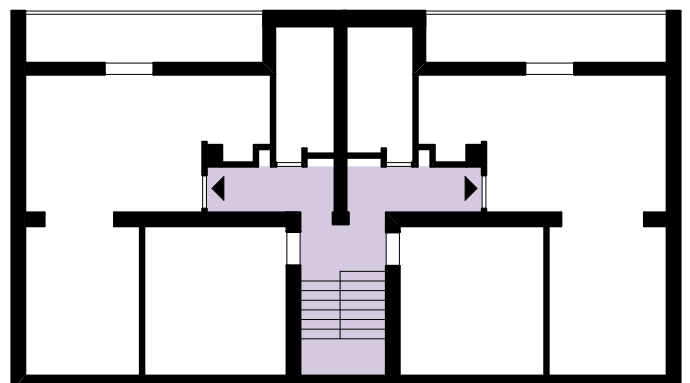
Wohnung der berufstätigen Frau, Grundrisse M1:200
